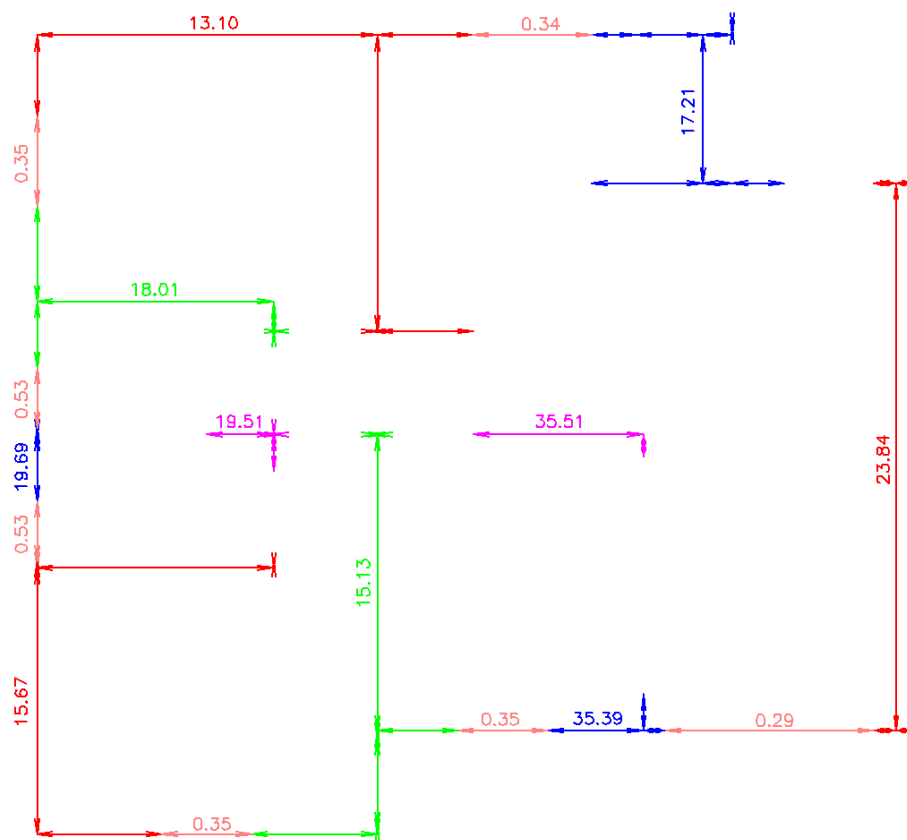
Intensidade (kN/m) das cargas verticais uniformemente distribuídas aplicadas no topo de cada pavimento do Caso II.
